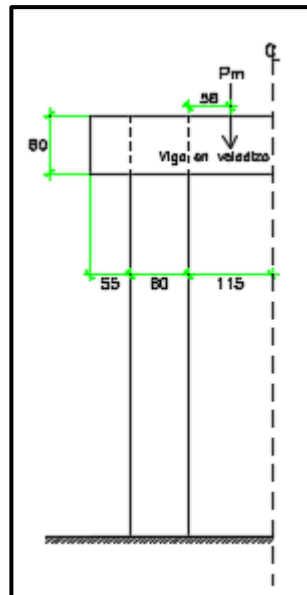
Aplicación De la carga muerta en la viga cabezal
